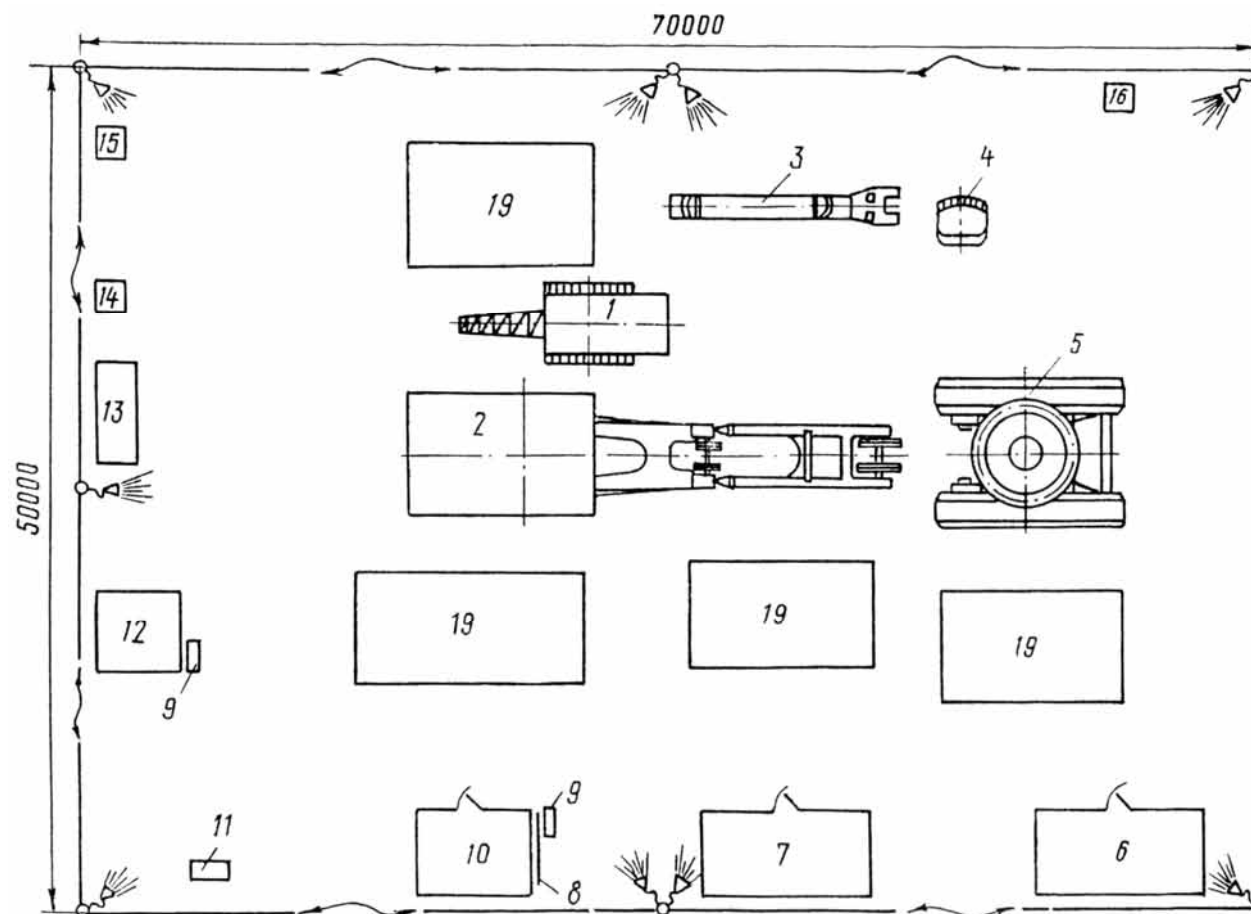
Схема расположения временных сооружений и оборудования на монтажной площадке:
